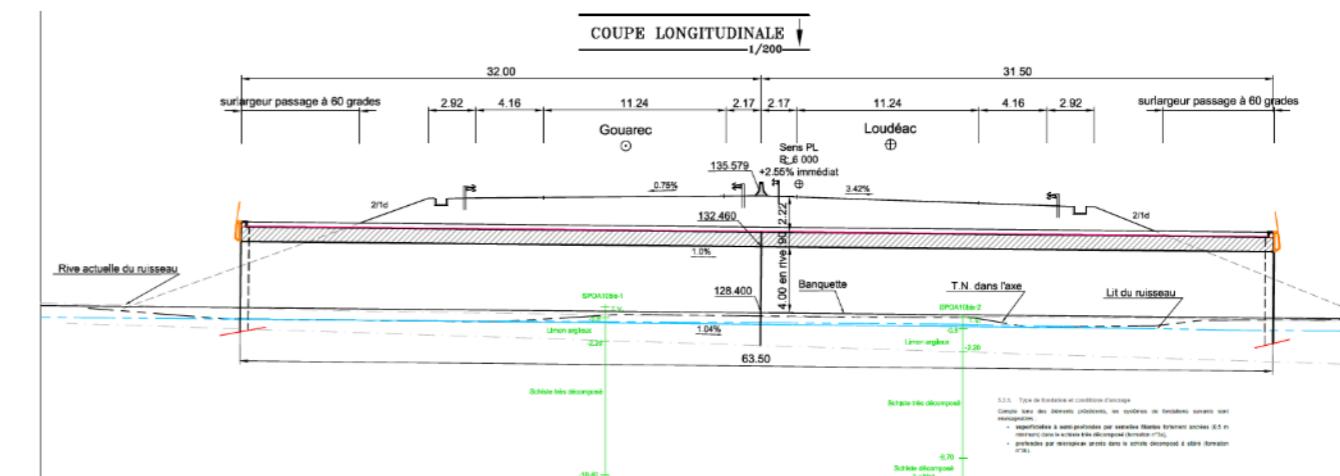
Coupe longitudinale de l'ouvrage OH10bis (source : SEGIC)
